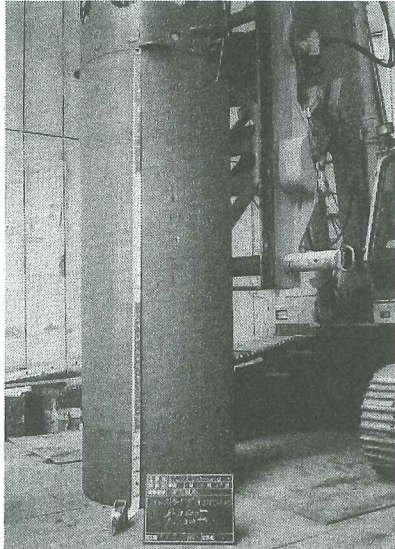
地中障害物地下床版コンクリート掘削に用いたケーシングチューブ
